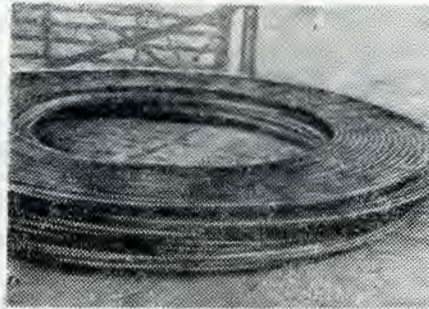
Арматурные каркасы «К», подготовленные для армирования перекрытия станции пражского метро «Музей».
